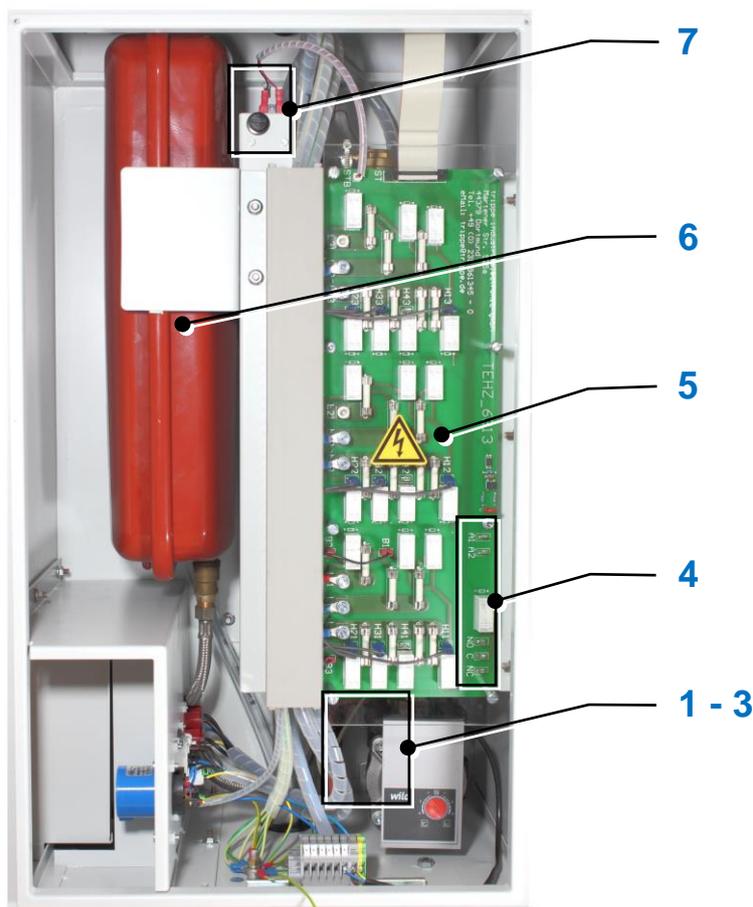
Innenansicht der mobilen Heizzentrale (beispielhaft)
